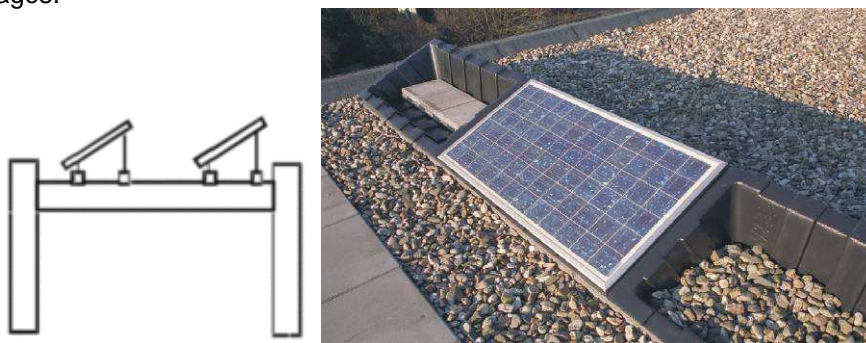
Photo et représentation schématique d'une technique de montage avec ballast de panneaux photovoltaïques sur une toiture plate (Hespul – 3E).
